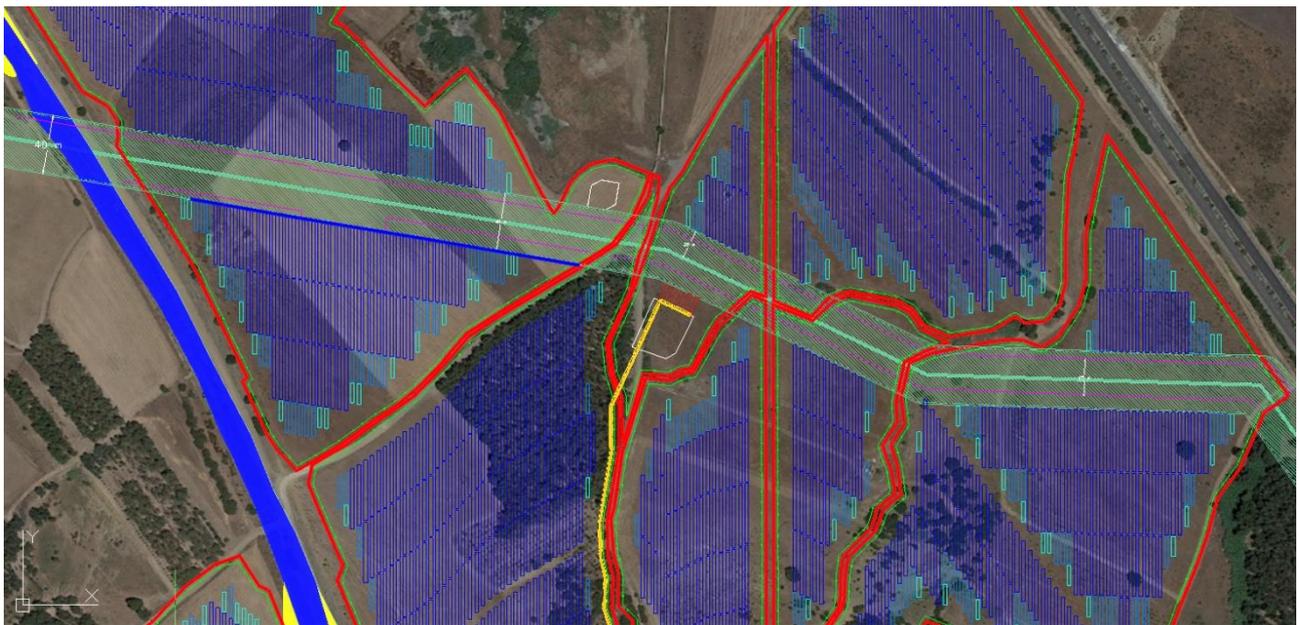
Dettaglio layout Lotto C rispetto al metanodotto Cagliari-Palmas Arborea (fascia di 20 m per parte)
